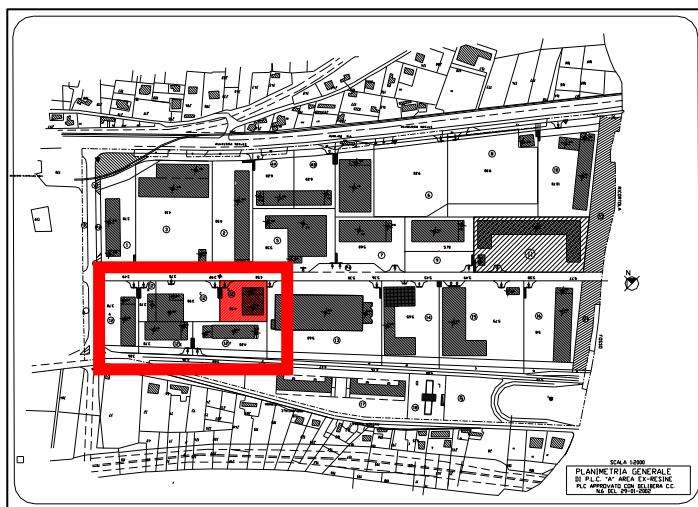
PLC AREA EX RESINE con stralcio lotto 12
